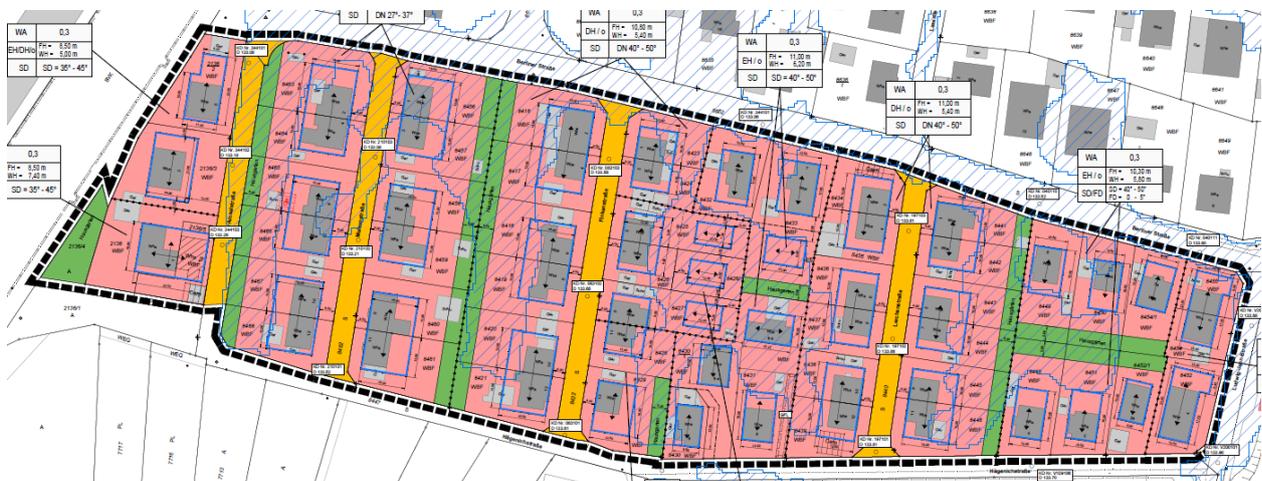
Bebauungsplanentwurf, Stand 22.06.2022
